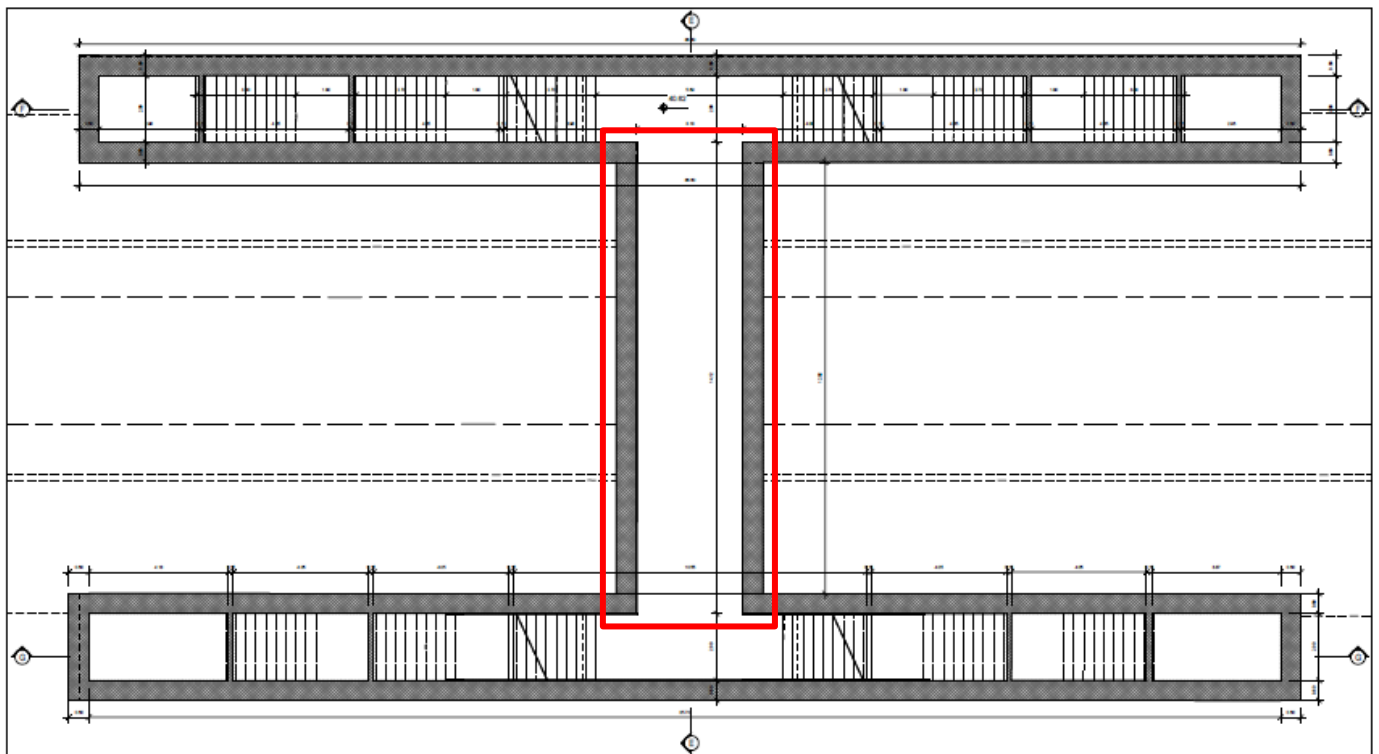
Planimetria dell’opera con individuazione del sottopasso
